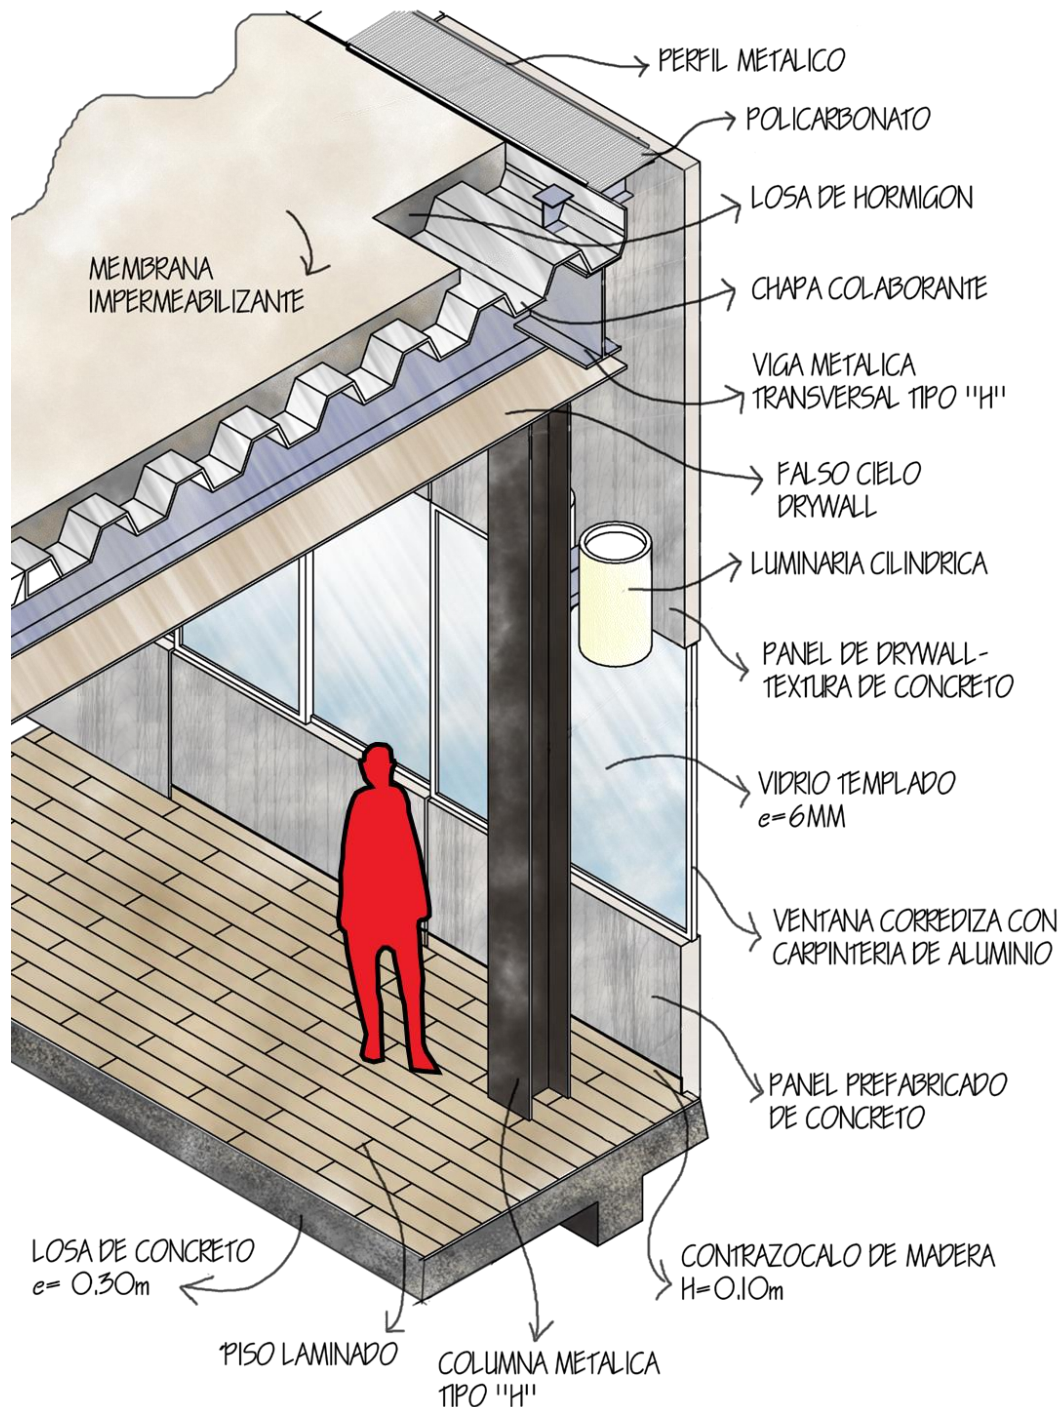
Detalle corte de muro de biblioteca y techo.
